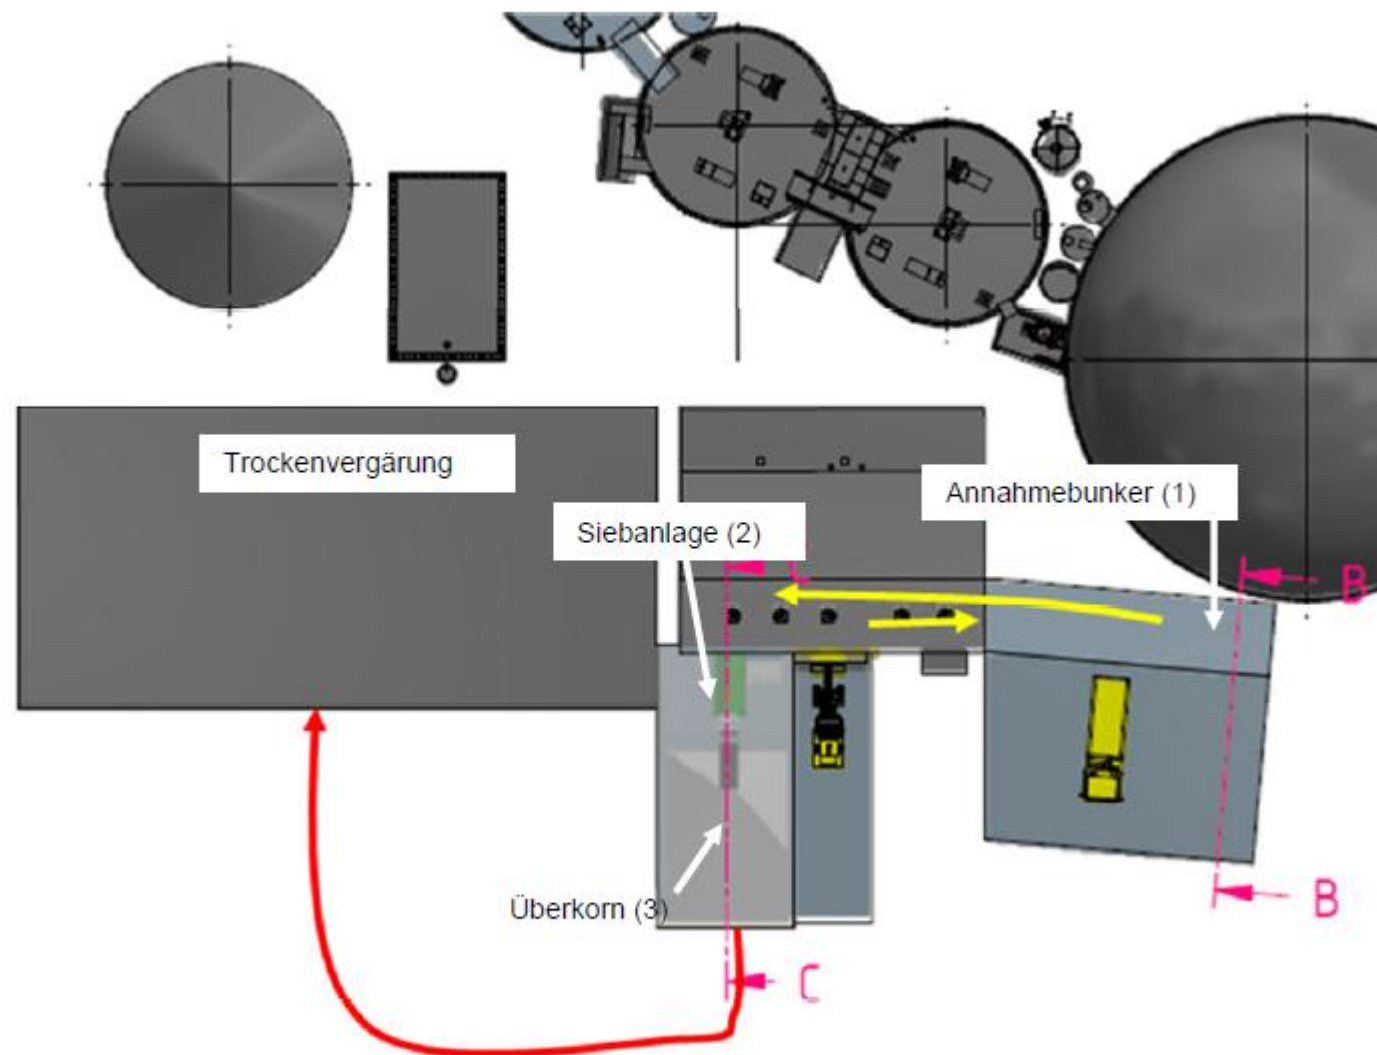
Layout 17: Anordnung der stationären Siebung in der bestehenden Aufbereitungshalle
